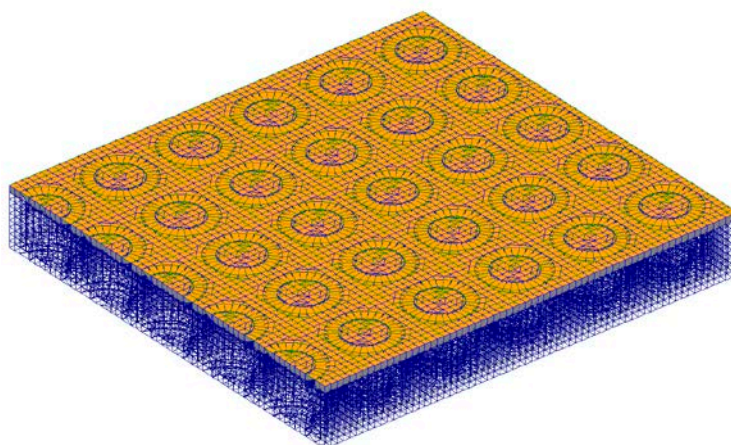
Схема действия постоянной нагрузки на плиту перекрытия с вкладышами пустотообразователями эллипсоидной формы
